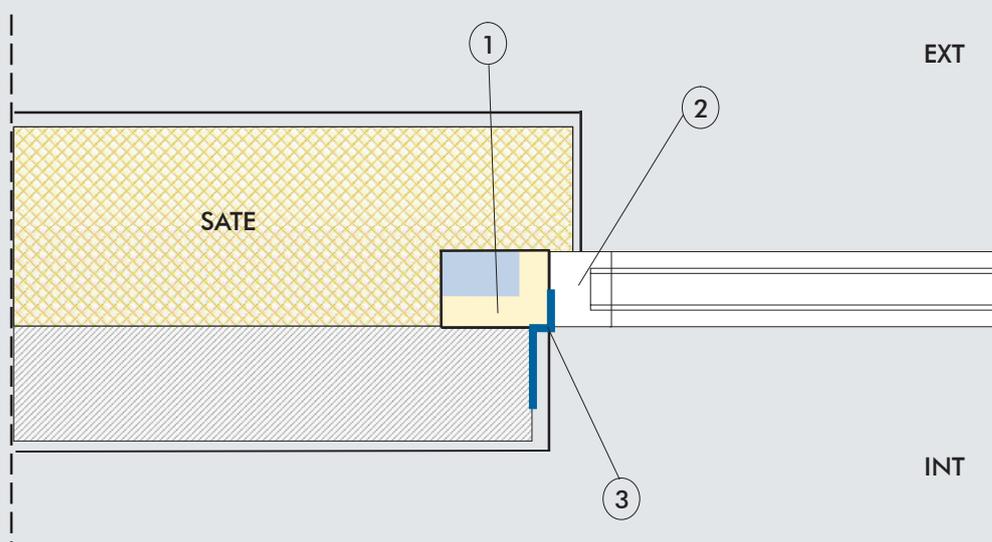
Carpintería en SATE con folio interior + Premarco aislante - Variante 1
